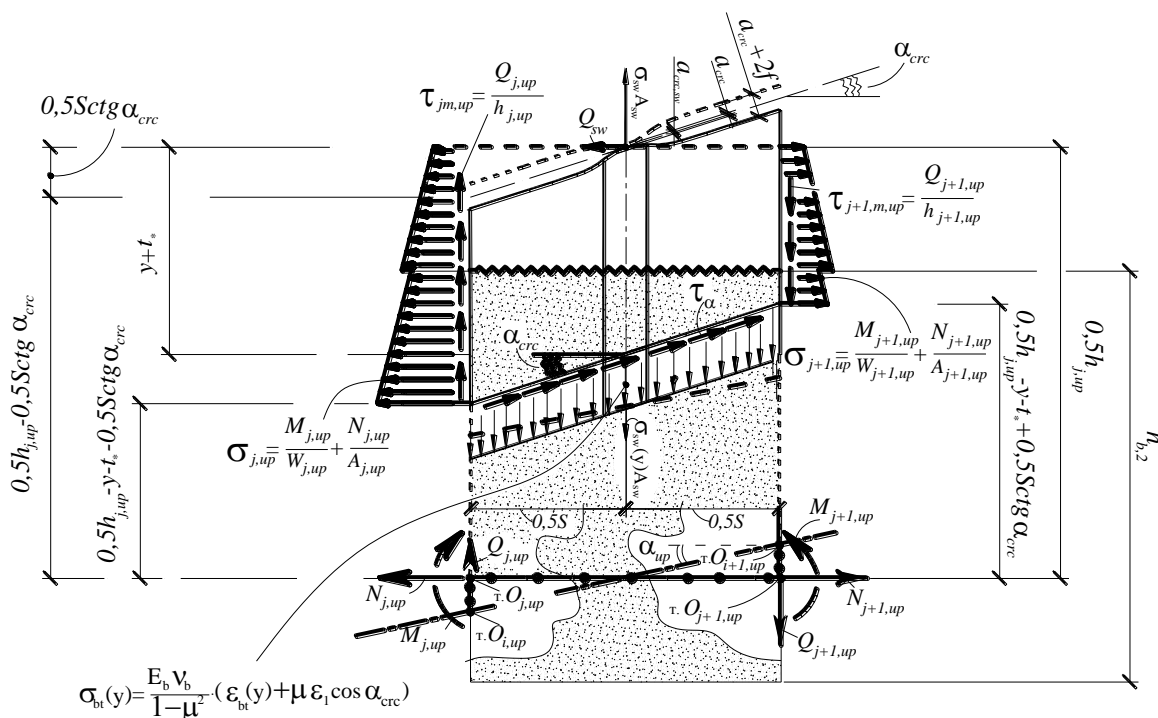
Расчетная схема к определению деформаций растянутого бетона $\varepsilon_{bt}(y)$ между наклонными трещинами первого, второго и третьего типов в железобетонной составной конструкции (случай 2)
